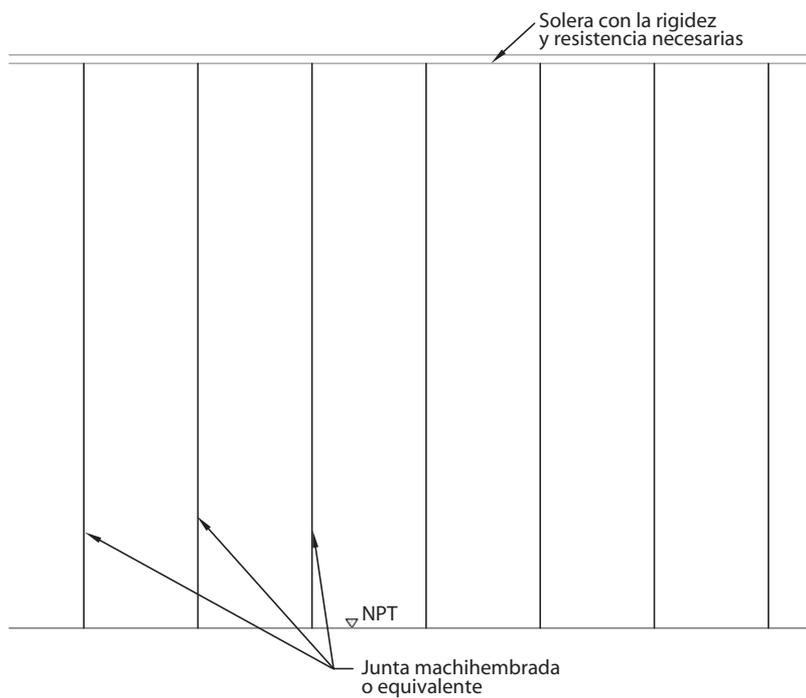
Paredes prefabricadas tipo baldosas verticales.
